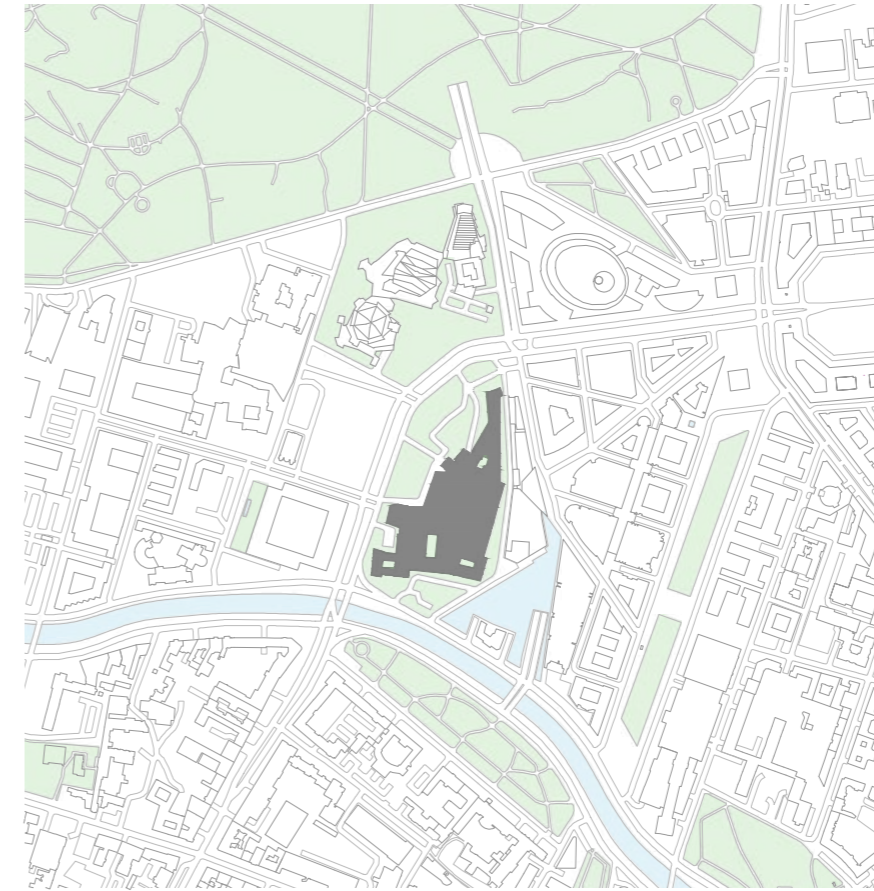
Planta de Cheios e Vazios, escala 1:10 000.
